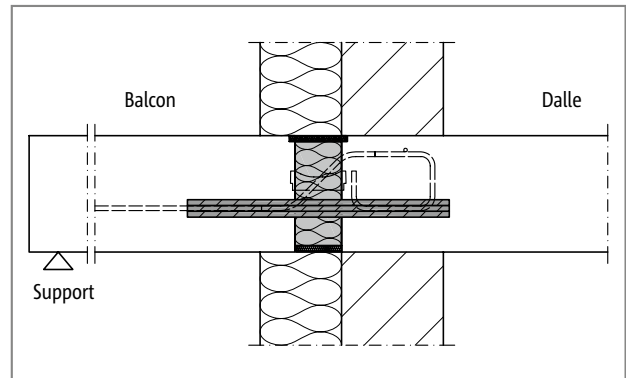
Schöck Isokorb® T Type H-VV-NN : Avec T type K-E, K-T ; raccordement avec isolation externe
